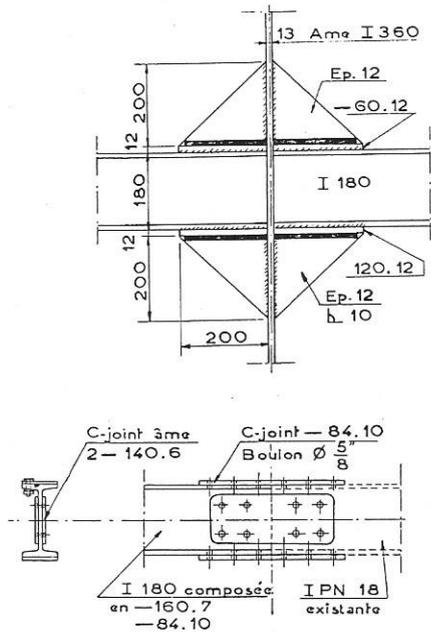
Modifications apportées aux linteaux reliant les colonnes en façade.
